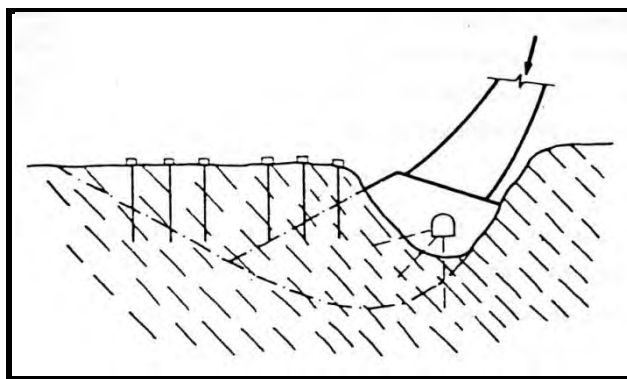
Estabilización utilizando anclaje y drenaje.
